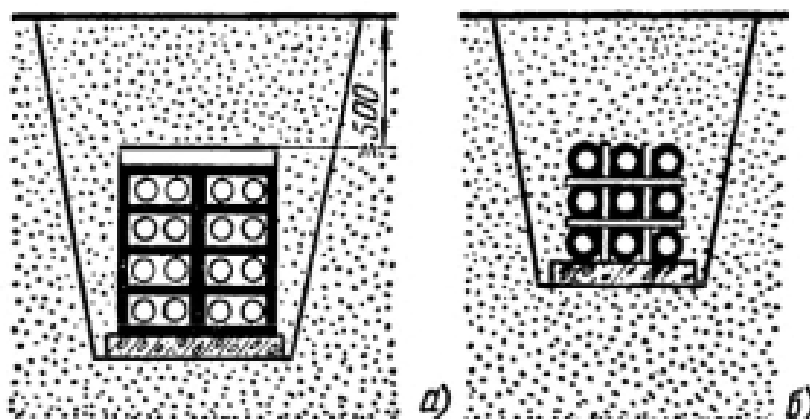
Прокладка кабелей в блоках: а) – блоки из железобетонных панелей, б) – блоки из асбоцементных или полимерных труб
